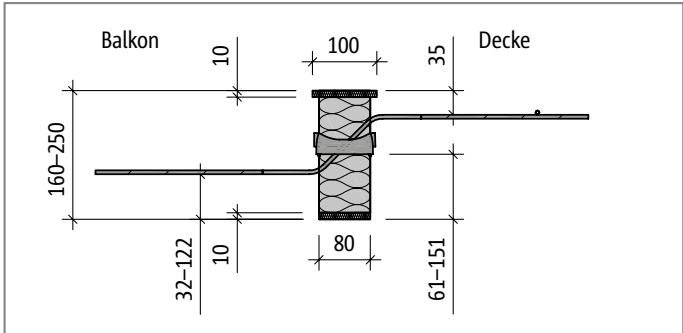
Schöck Isokorb® T Typ Q-ID-V1
